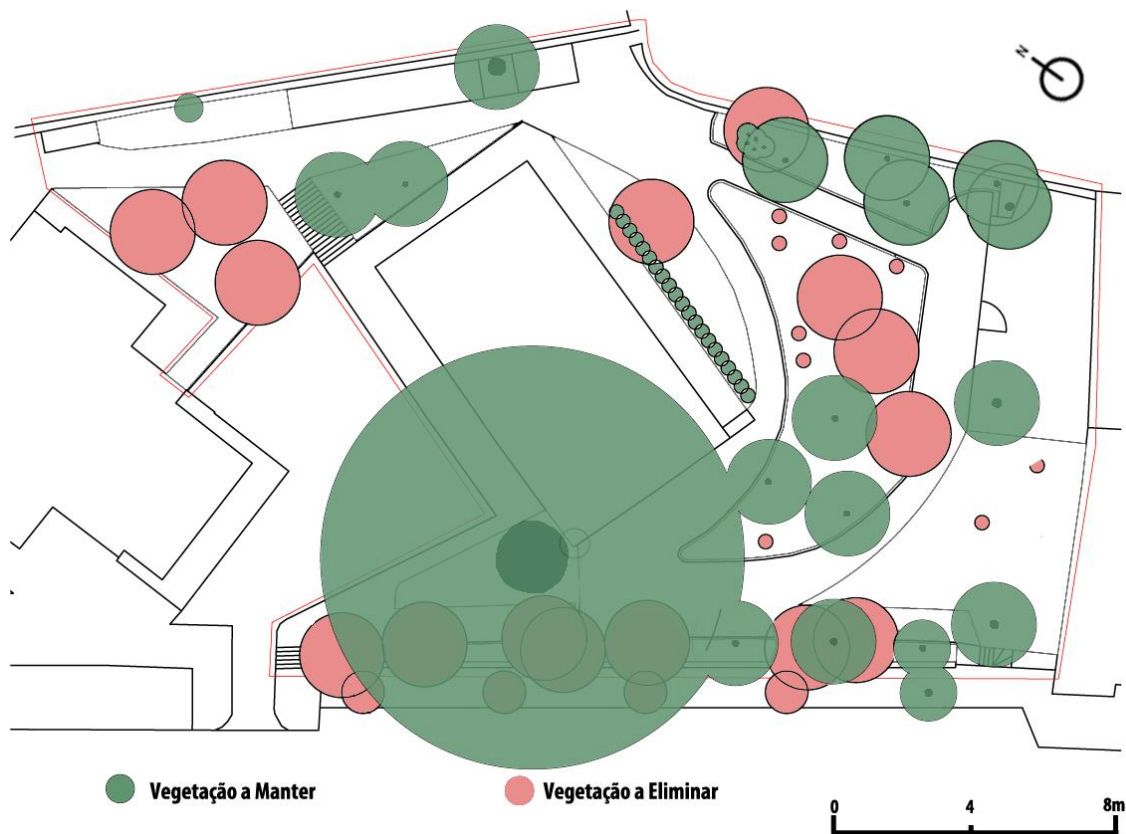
Planta de Vegetação a Manter e a Eliminar.
